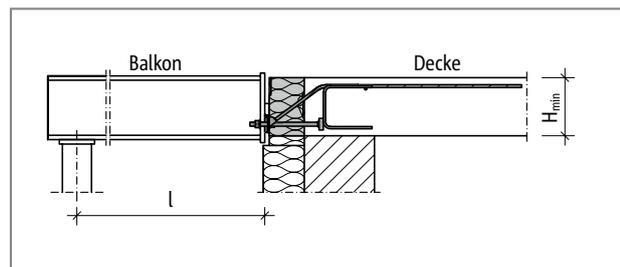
Schöck Isokorb® XT Typ SQ: Statisches System
